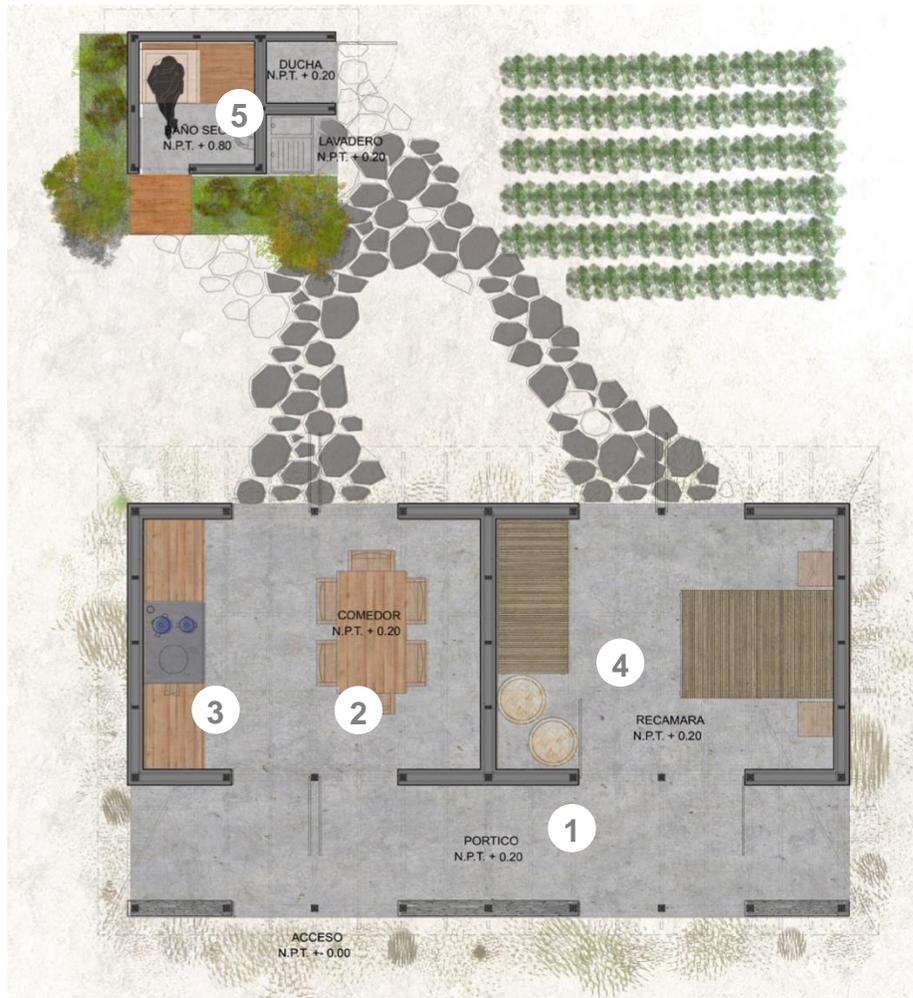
Planta arquitectónica del modelo de vivienda básica.
